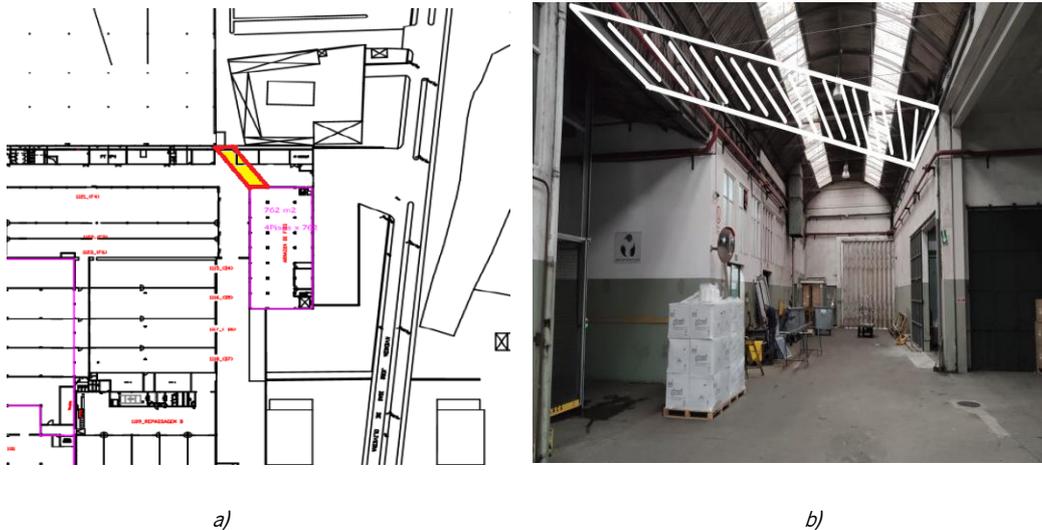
Plataforma Silos – Tecelagem: a) Planta b) Ilustração
